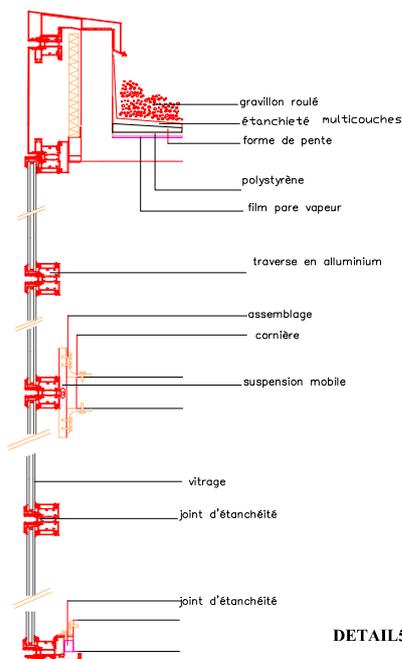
ASSEMBLAGE TOITURE AVEC POTEAU
